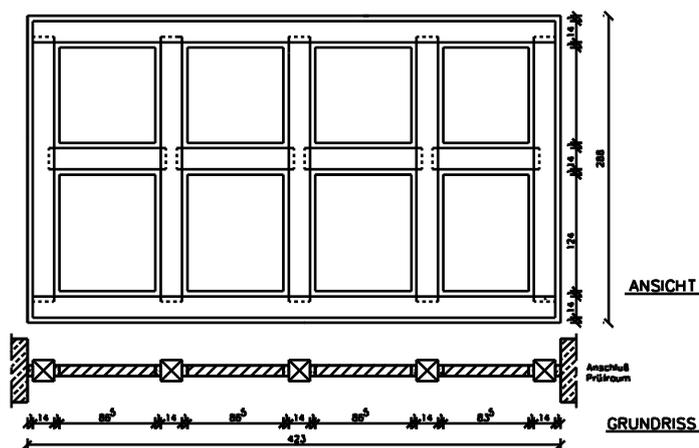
Grundriss und Ansicht der Fachwerkwand
